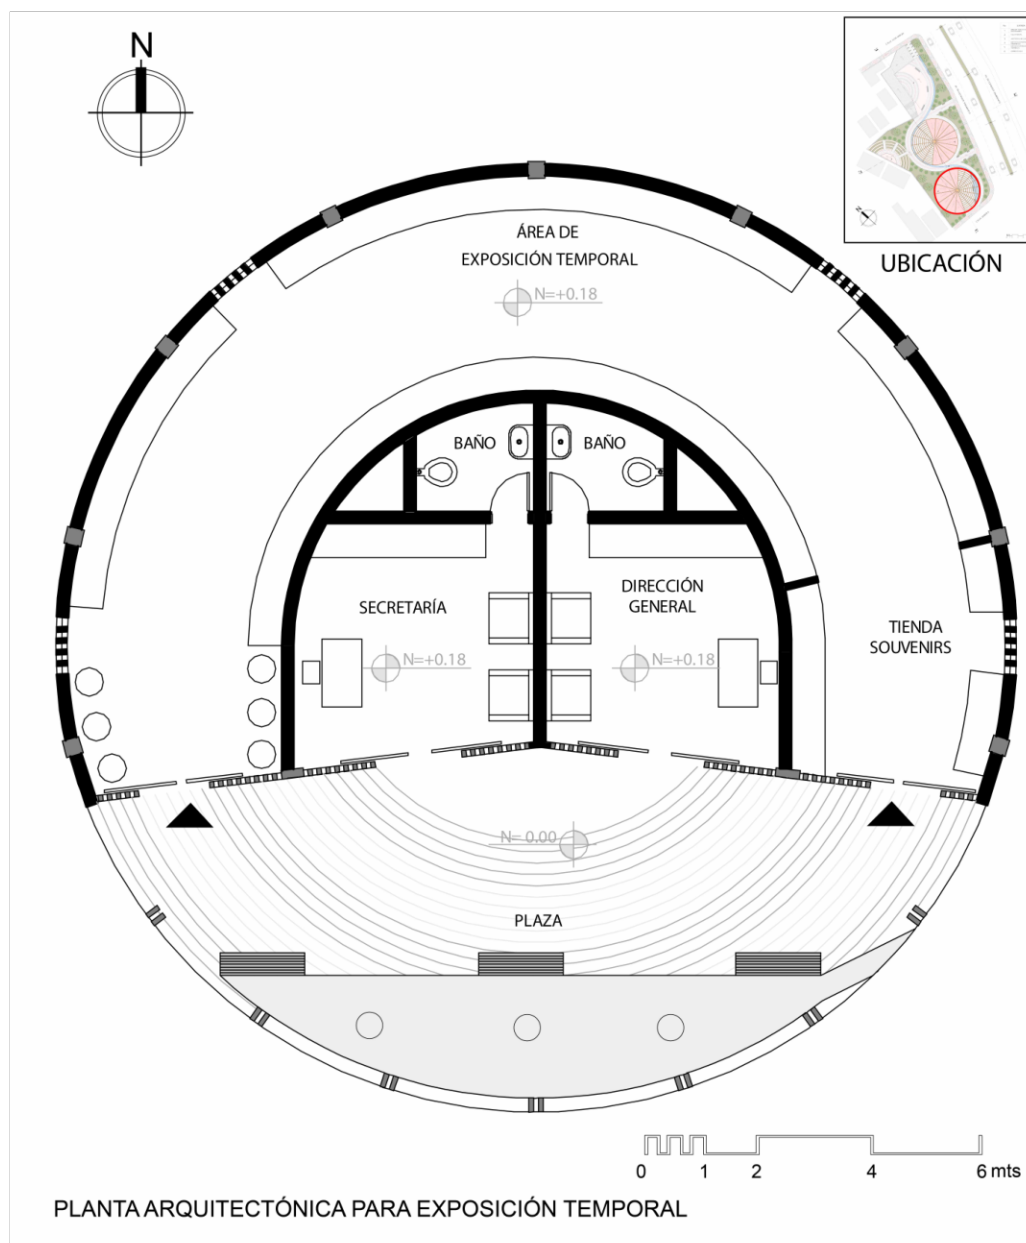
Planta arquitectónica del bloque 2 de exposición temporal
